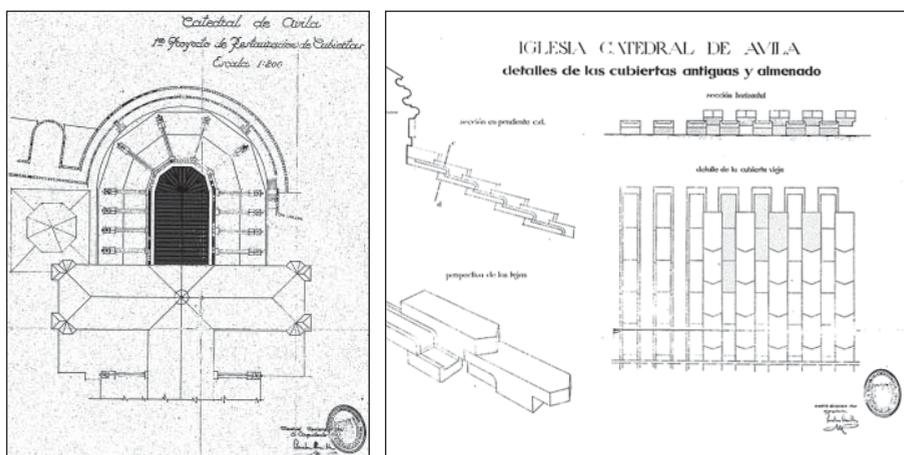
Plano de actuación en la cubierta del presbiterio y detalle de cubiertas de piedra y almenado (IPHE).
